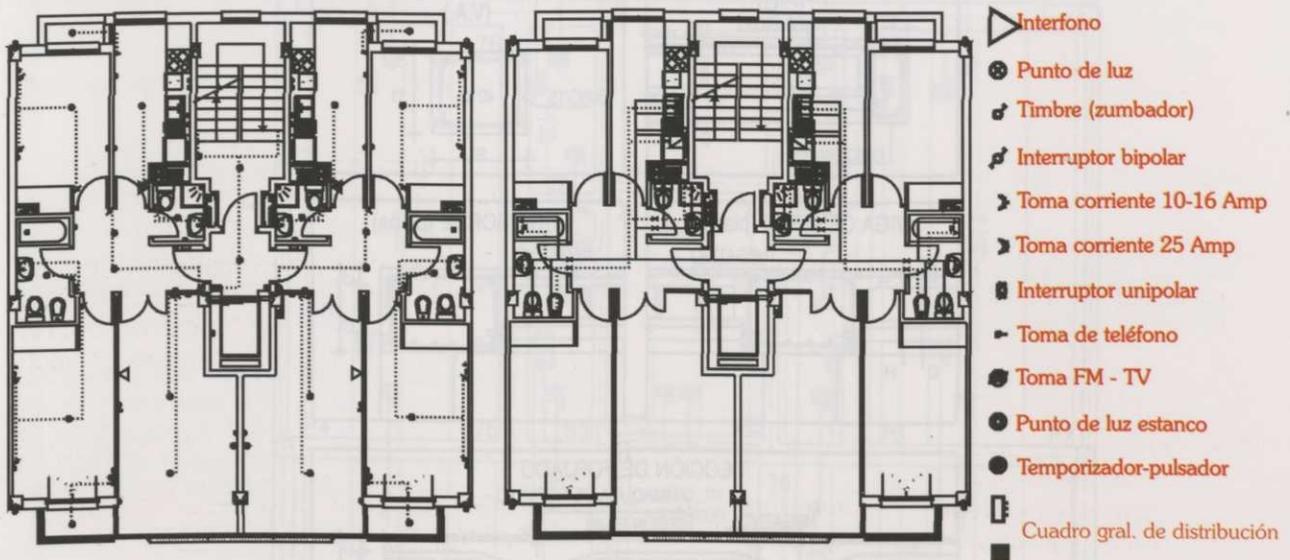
Detalle plano de planta instalaciones con cuadro-leyenda.
